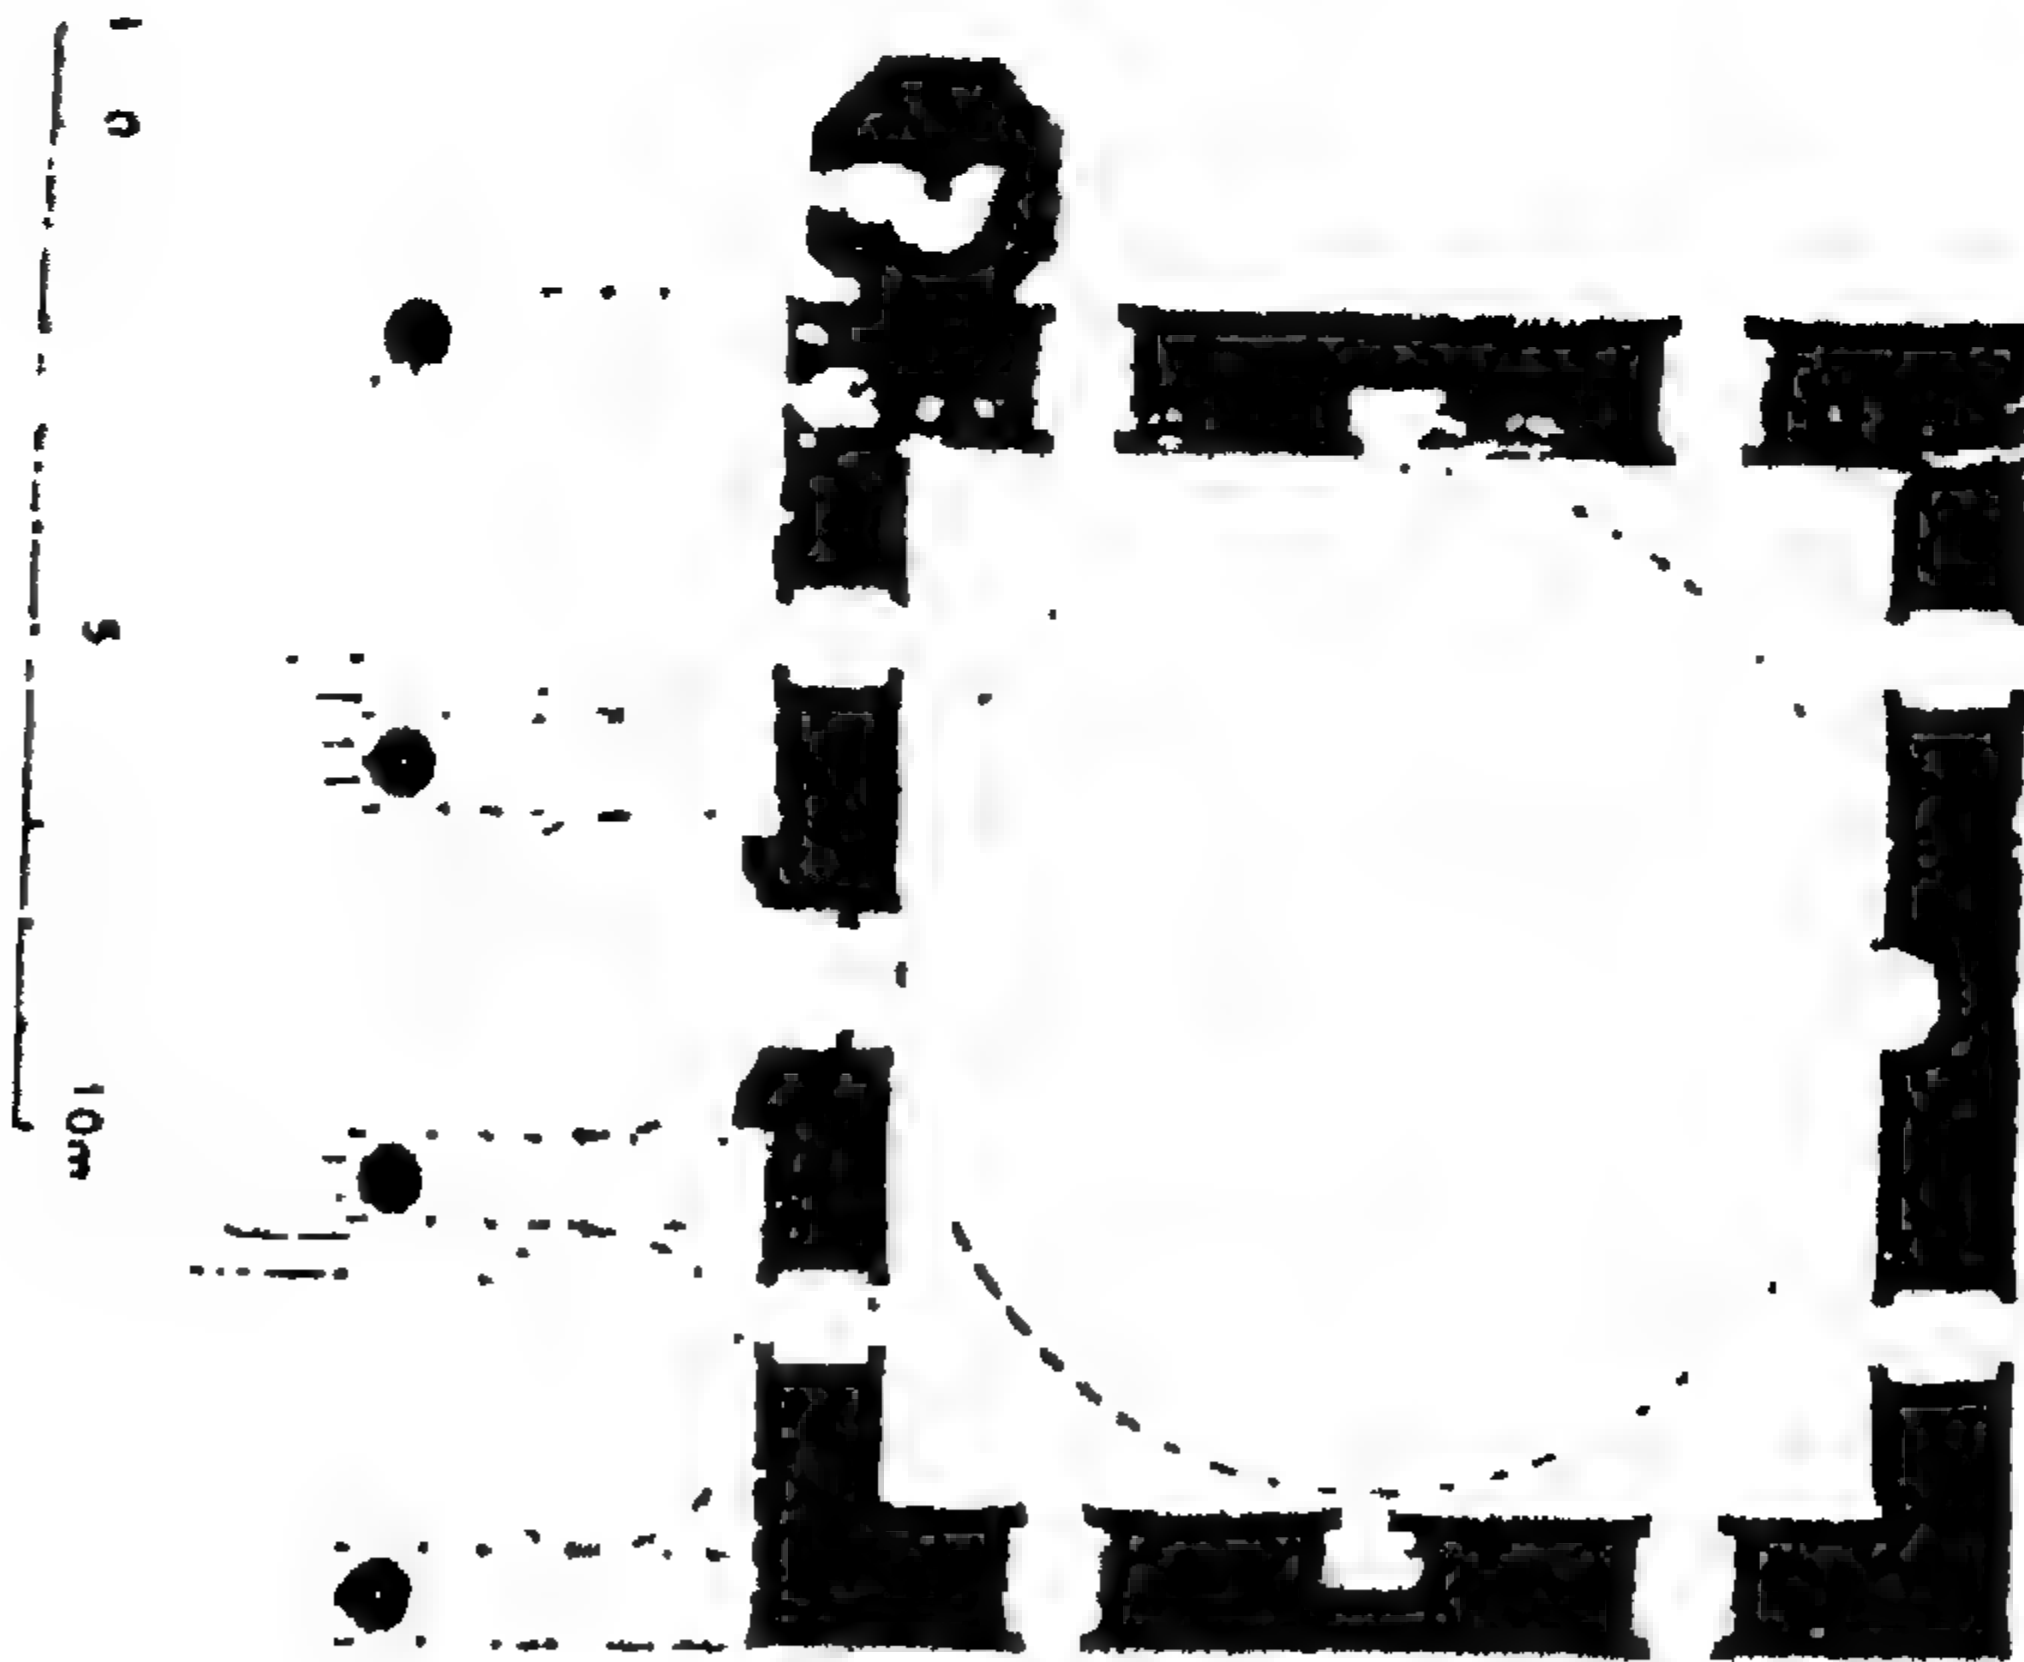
مسقط أفقي لمسجد صرجالي بقونية (عن : Aslanapa) .
